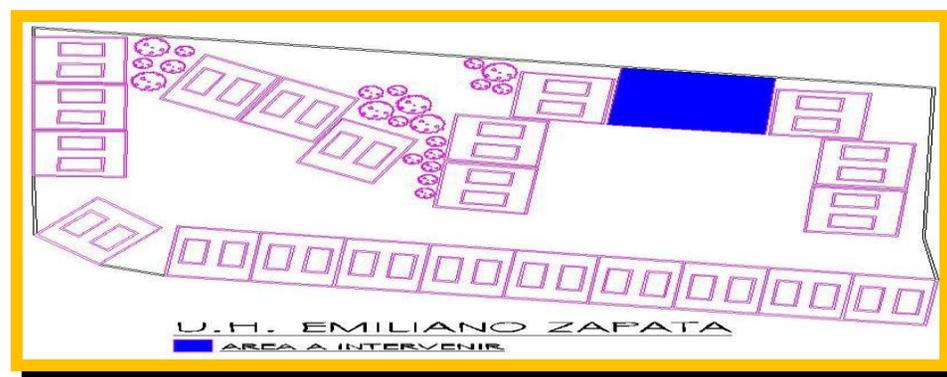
Croquis de la unidad habitacional Emiliano Zapata (área a intervenir)
